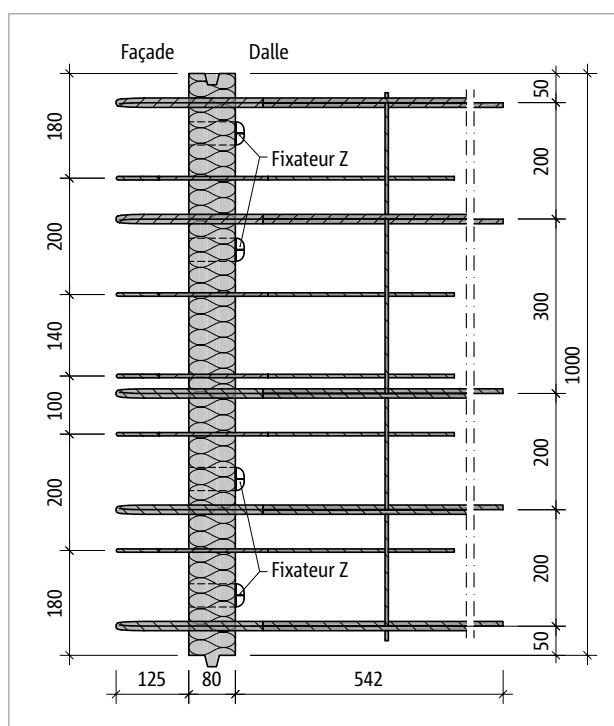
Schöck Rutherma® T type DFi-V4-LR125 : vue en plan du produit
